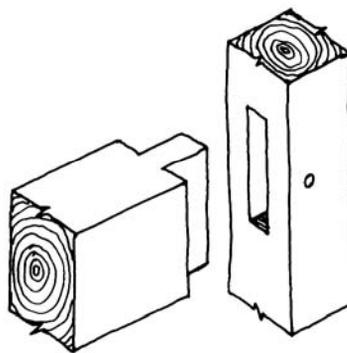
Ensamble de caja y espiga en el apoyo de una viga sobre un pilar pasante.
